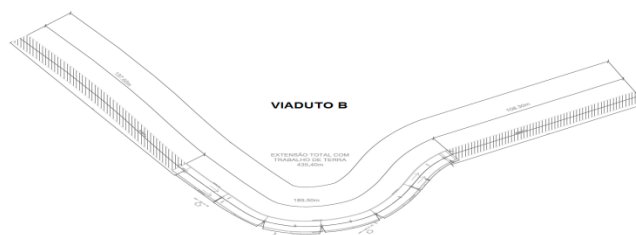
Panorama do Viaduto B: Comprimento da Estrutura/Trabalho de Terra
